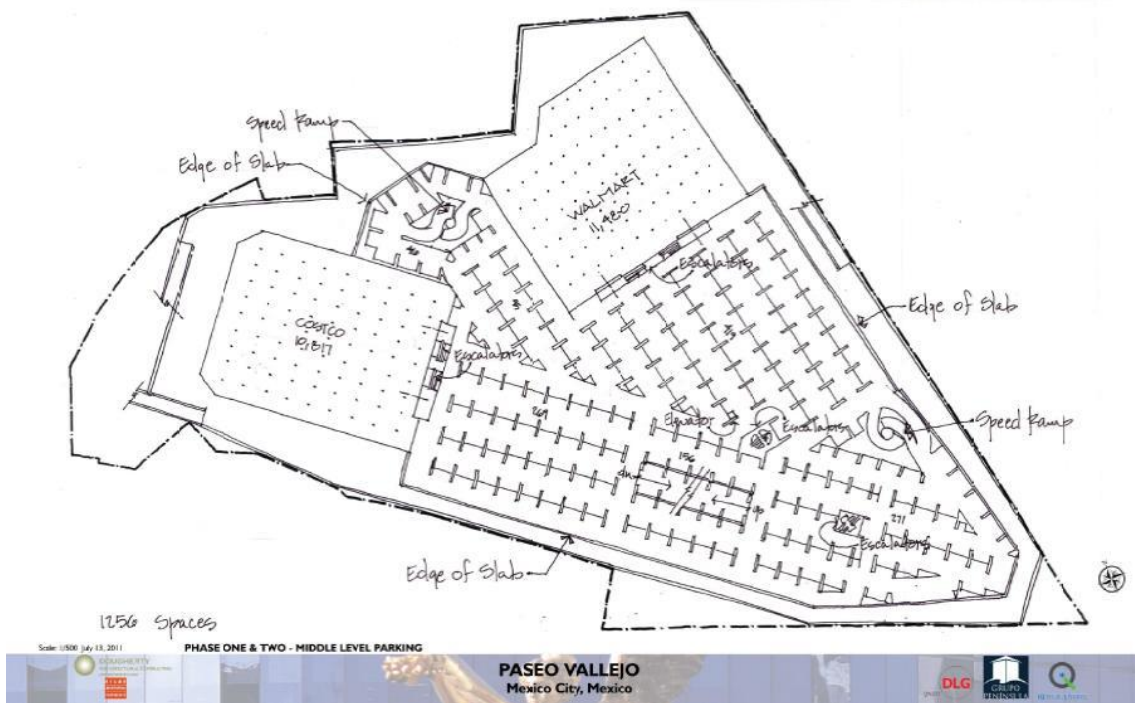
SEMBRADO DE LAS ESTRUCTURAS DE INTERES
